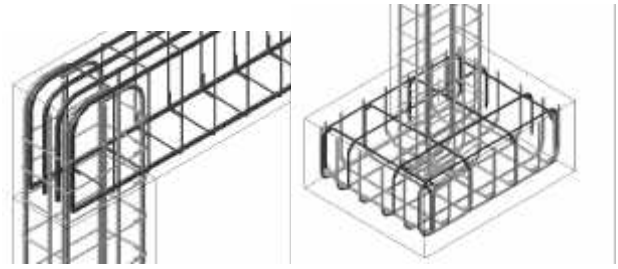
Acomodação de varões nas zonas de ligação entre elementos estruturais.
